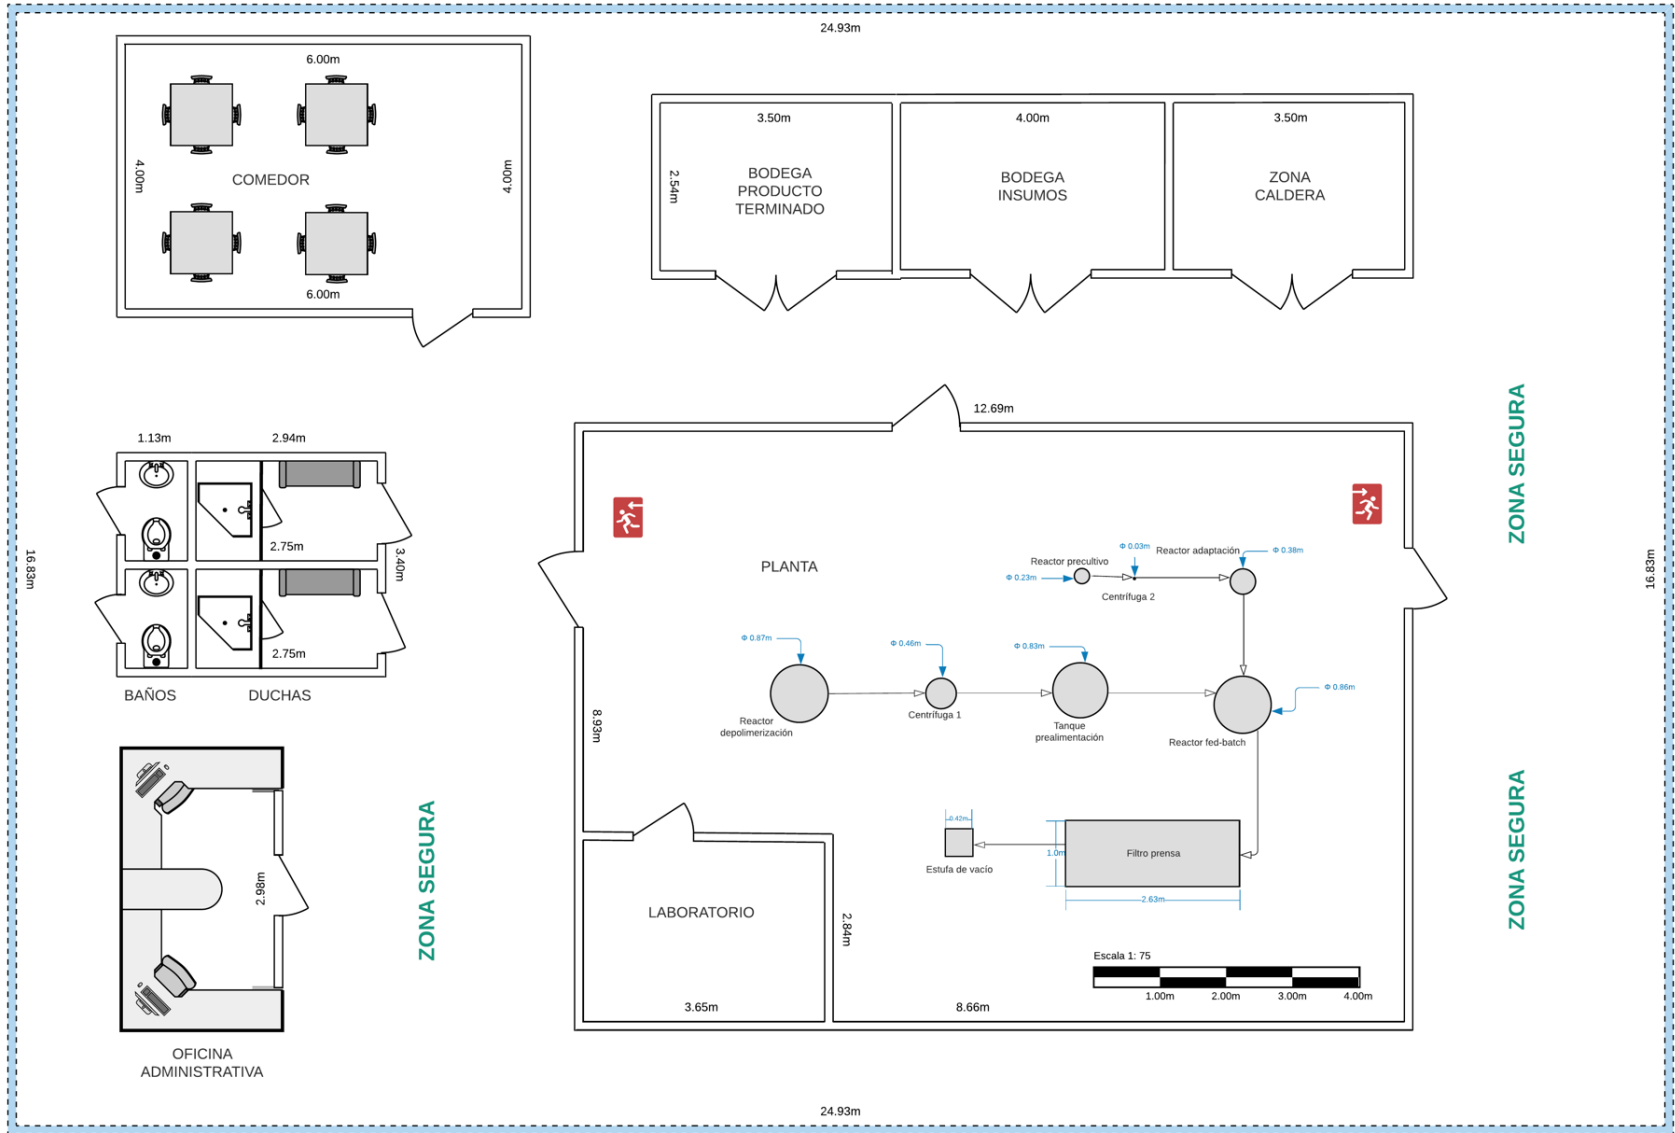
Layout preliminar de la planta piloto de producción de SCP.
